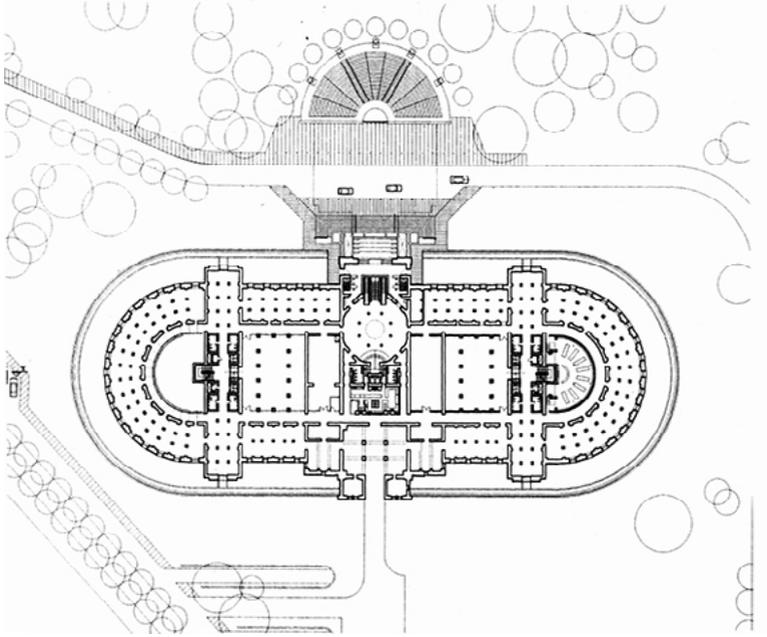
Proyecto de ampliación del Museo de La Plata, propuesto por el arquitecto platense Vicente Krause. Foto: Revista de la Facultad de Arquitectura y urbanismo, UNLP, 47 al fondo, año 1997.
